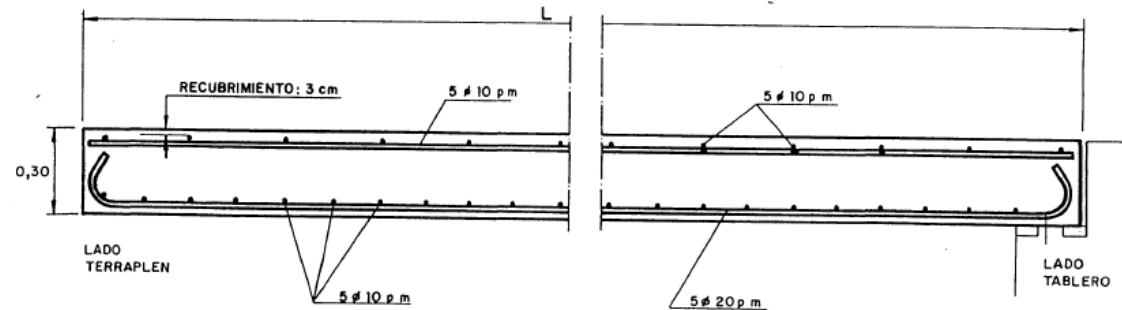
Recomendación de armado para losa de transición. Fuente: Nota de servicio sobre losas de transición en obras de paso.
